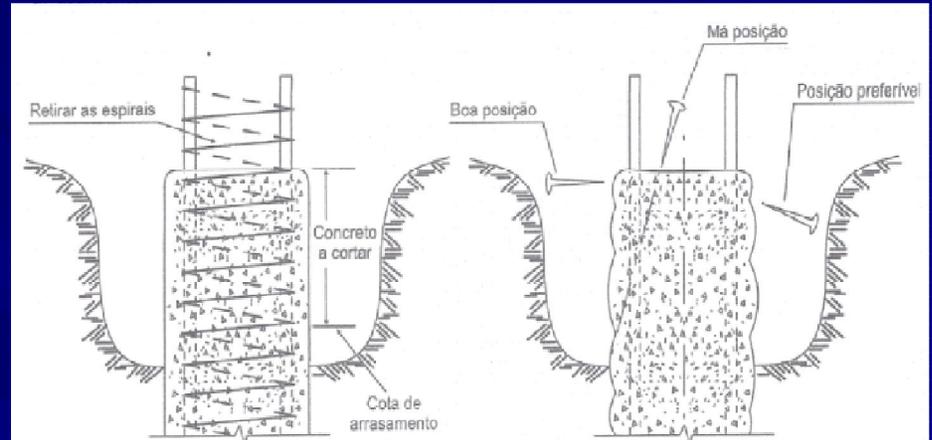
Escavação até cerca de 20 cm abaixo da cota de arrasamento
